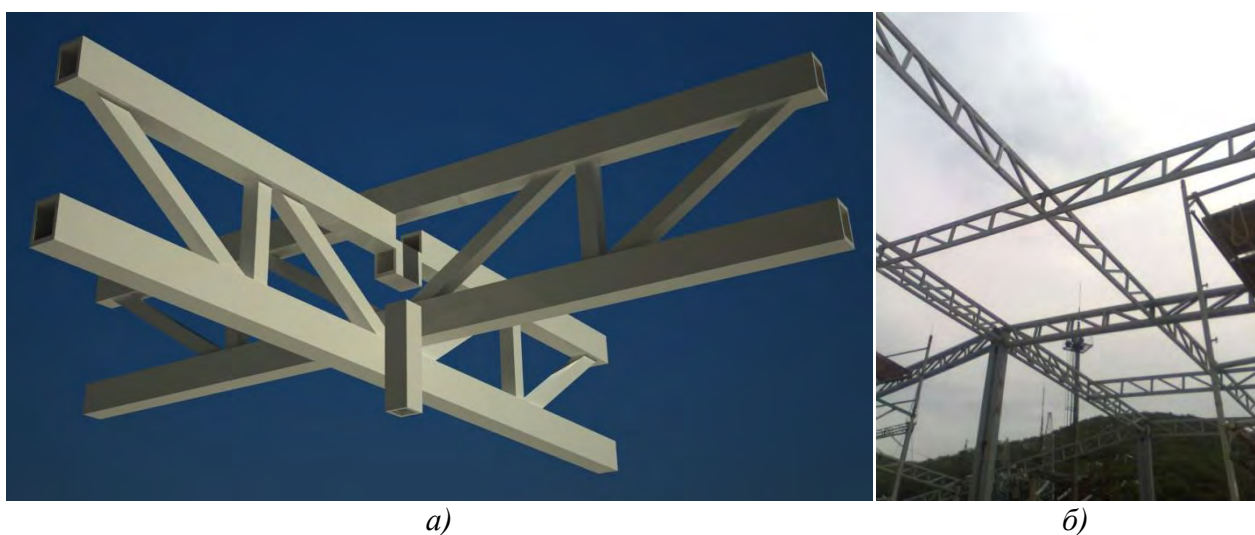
Схема узла сопряжения перекрестных ферм с монтажным окном в верхнем (сжатом) поясе модернизированного модуля (а) и снимок его общего вида (б)
